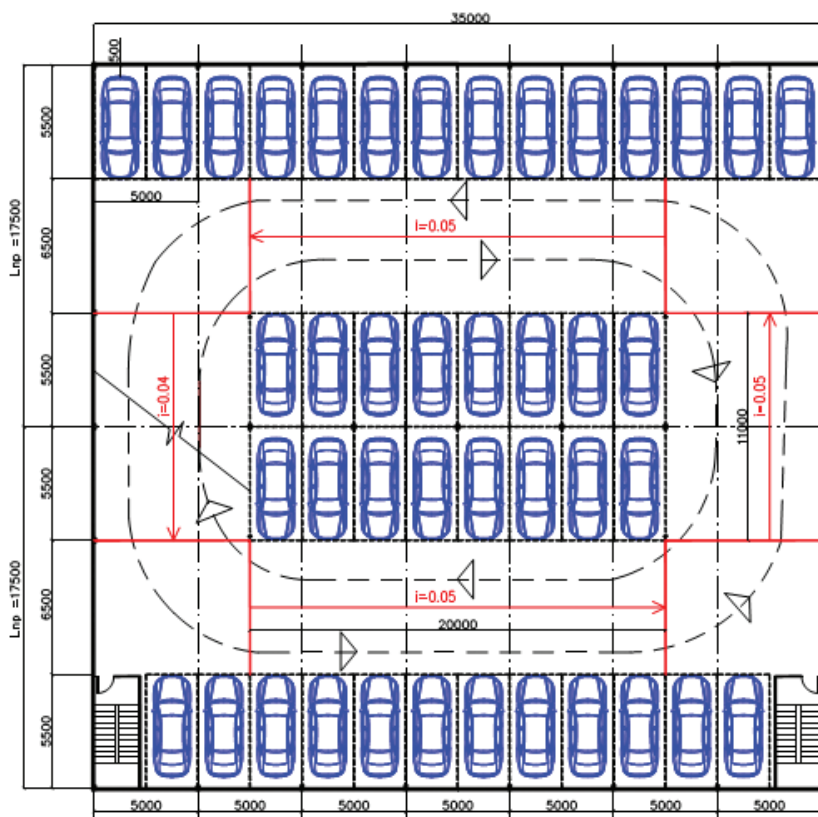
План типового этажа для НМРА с наклонными перекрытиями
